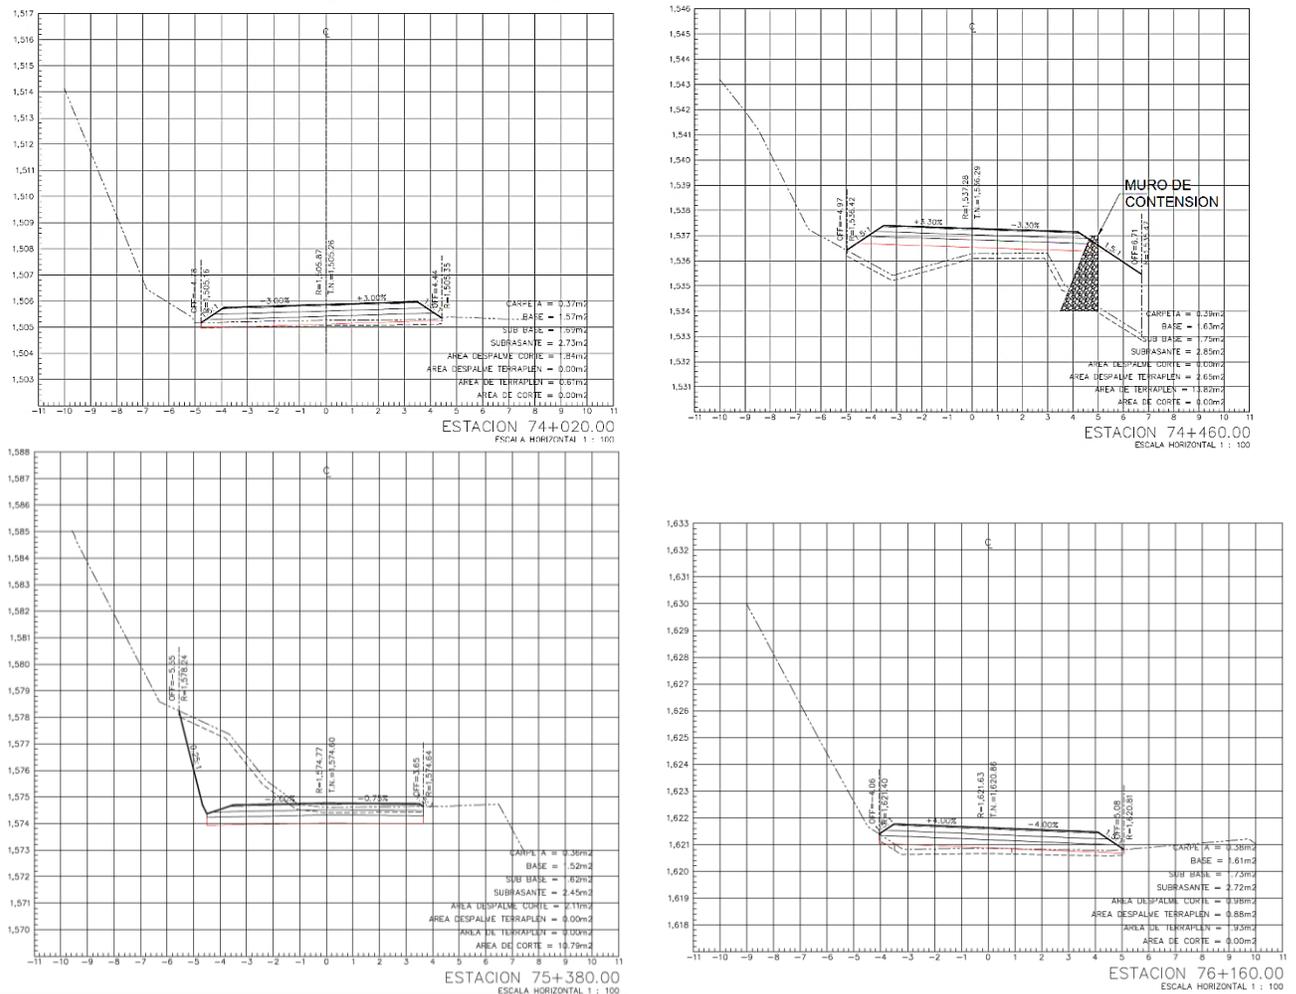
Secciones transversales del camino propuesto a pavimentar
